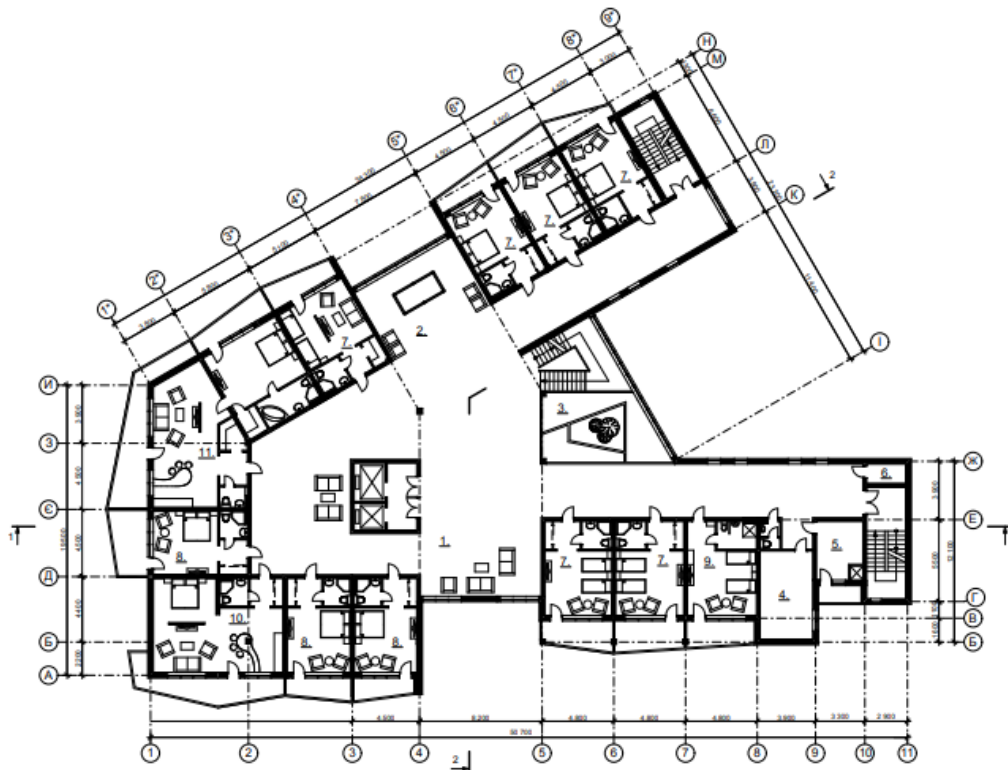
Креслення плану 3-5 поверхи
